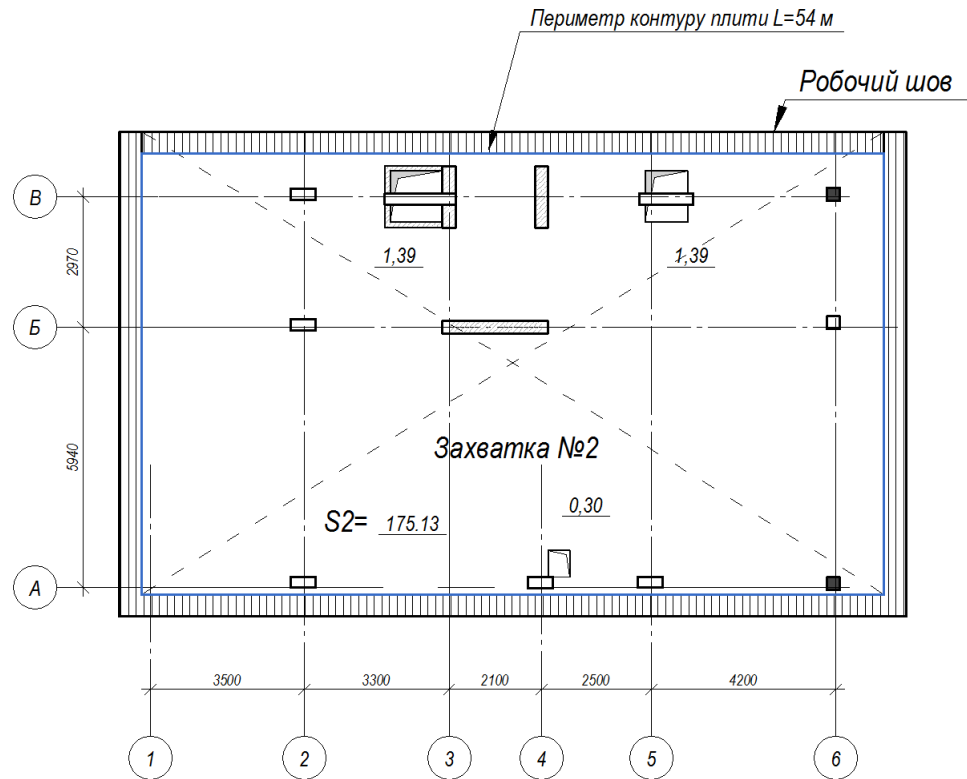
Схема до визначення площі опалубки перекриття марки ПМ 2
